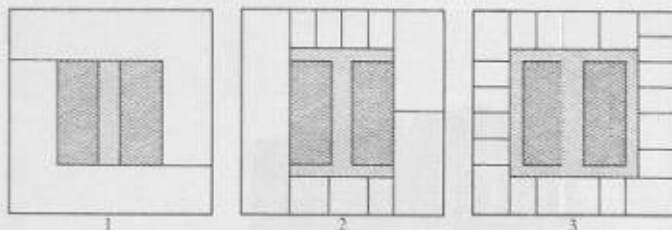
Drei mögliche Schemata der Grundrissgestaltung
